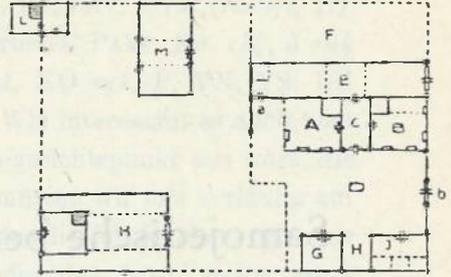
Grundriss eines weissrussischen gehöftes. Nach Nikiforowskij.
